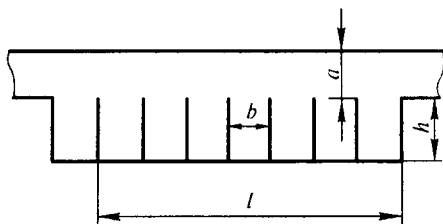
Схема резонаторного глушителя ячеистого типа:
